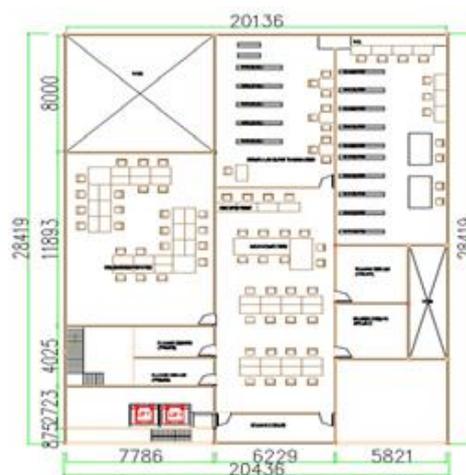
Site Plan Lokasi Perpustakaan Kampus Meruya. (Sumber : [Biro MGS UMB](#)).
